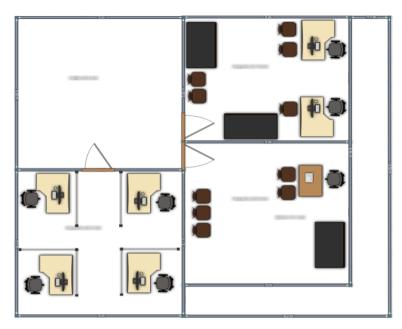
A. Plano del GAD Parroquial de Quiroga.
